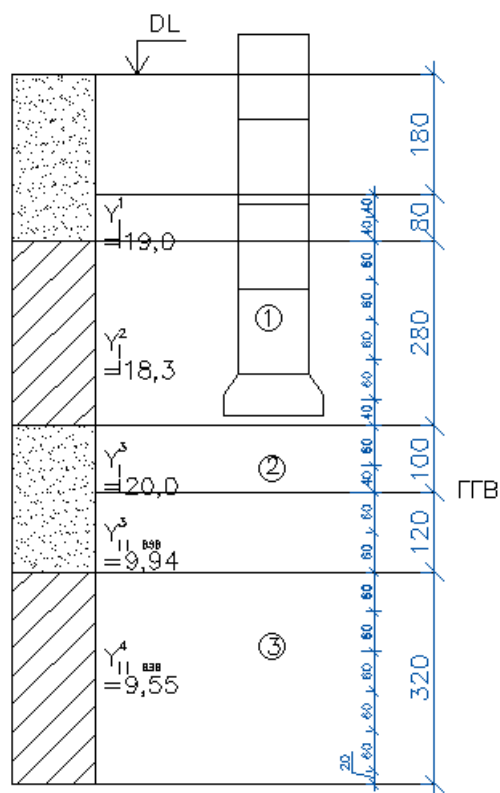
Размещение фундамента на инженерно-геологическом разрезе
